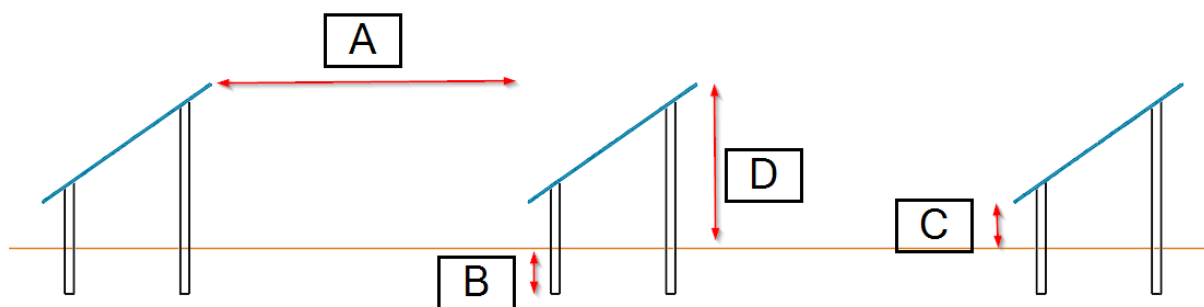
til 3-7 illustrerer hvordan anlegget vil utformes og se ut når det er ferdig installert. Illustrasjonene er laget i PVcase og AutoCAD.
